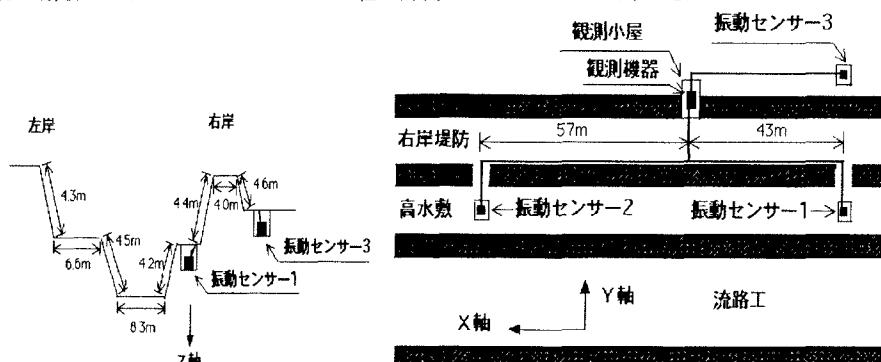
野尻川の流路工における振動センサーの設置状況：横断図と平面図
